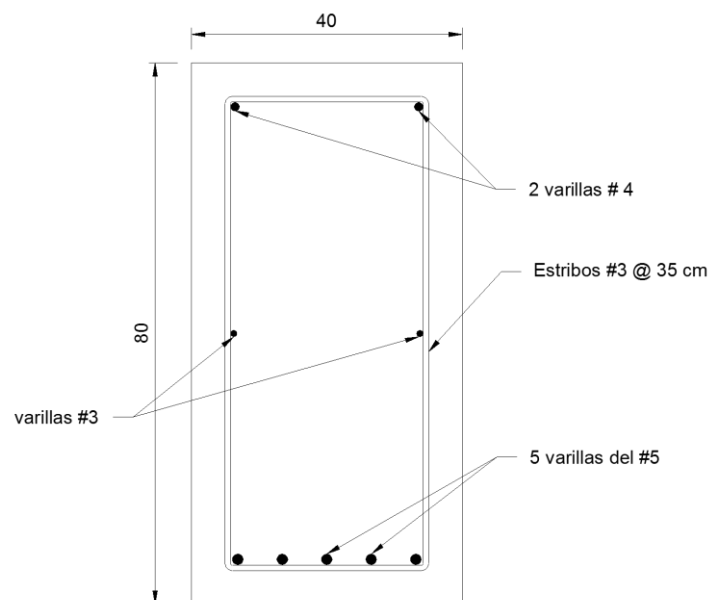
Detallado de acero longitudinal de vigas secundarias.
